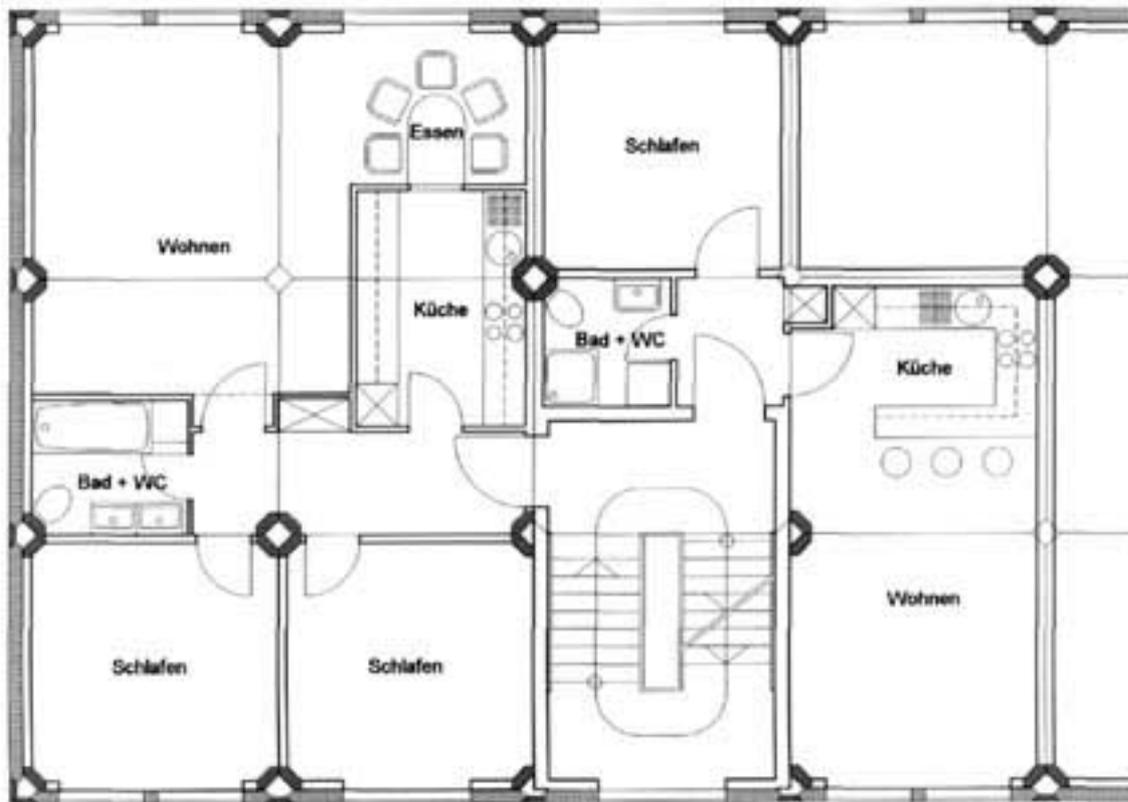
Grundrißbeispiel für einen Geschosswohnungsbau in Halberstadt⁴⁸¹
